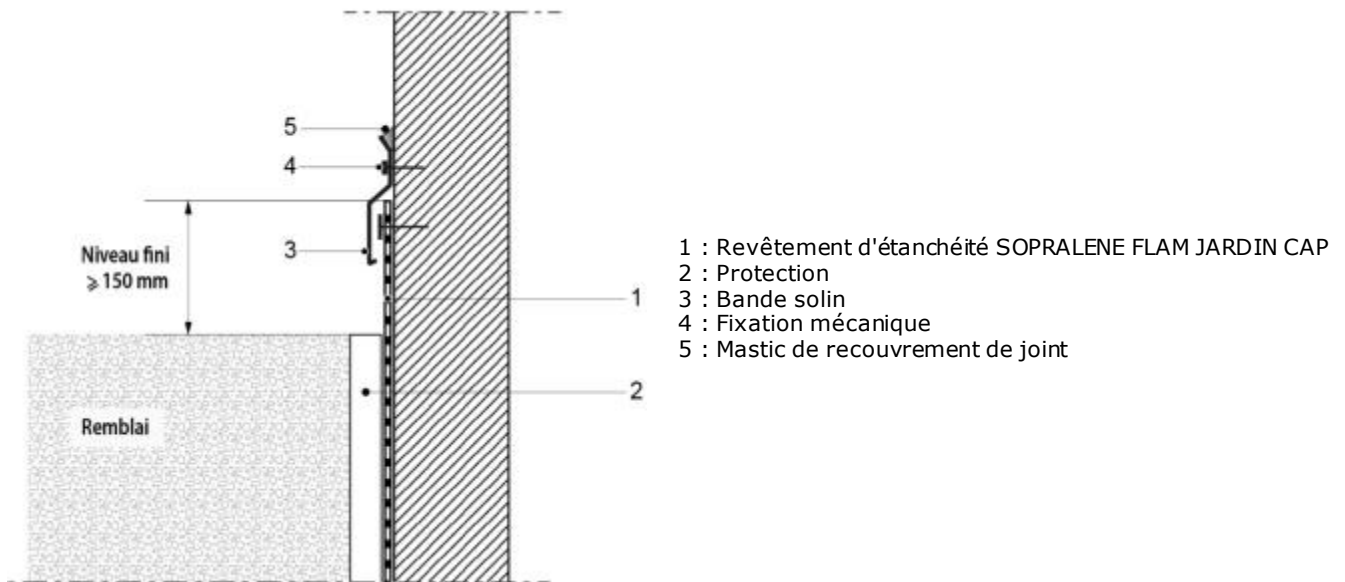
Exemple de dispositif en tête d'ouvrage dans le cas d'une zone non accessible (absence de protection mécanique de la membrane d'étanchéité dans la zone hors sol)
